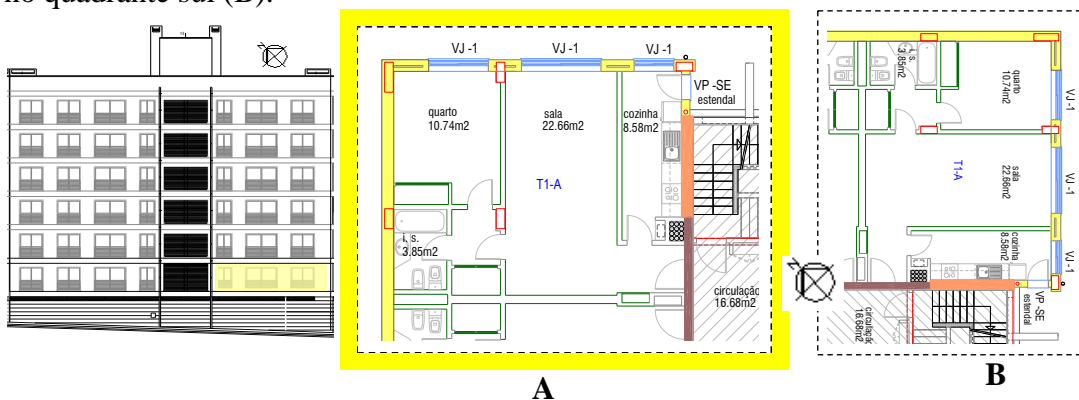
Fachada a Nordeste e planta do apartamento (sala e quarto de dormir – tipologia T1).
